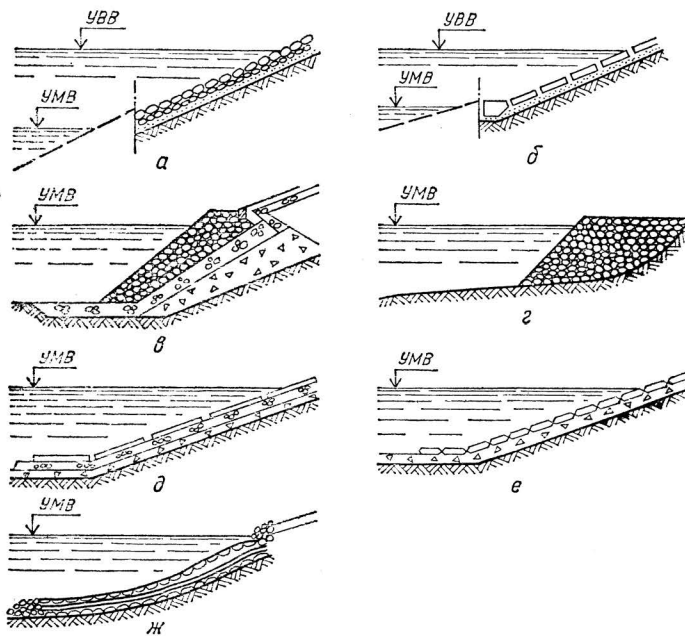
Крепление береговых откосов в зоне переменного уровня (а, б) и в подводной зоне (в — ж): а — мощение камнем; б — железобетонные плиты; в — каменнанабросная опояска; г — контрбанкет; д — железобетонные плиты; е — железобетонный тюфяк; ж — каменно-хворостяной тюфяк.
